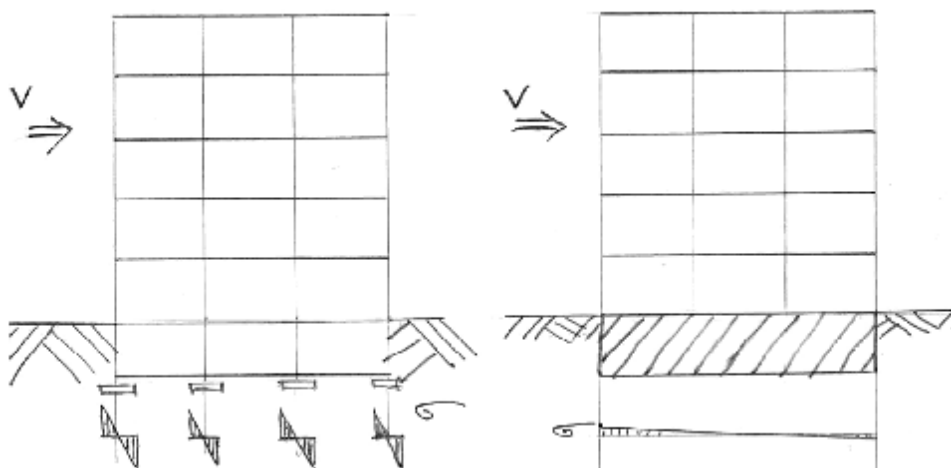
Un radier général raidi par les murs de sous-sol base réduit les contraintes à la fondation.
